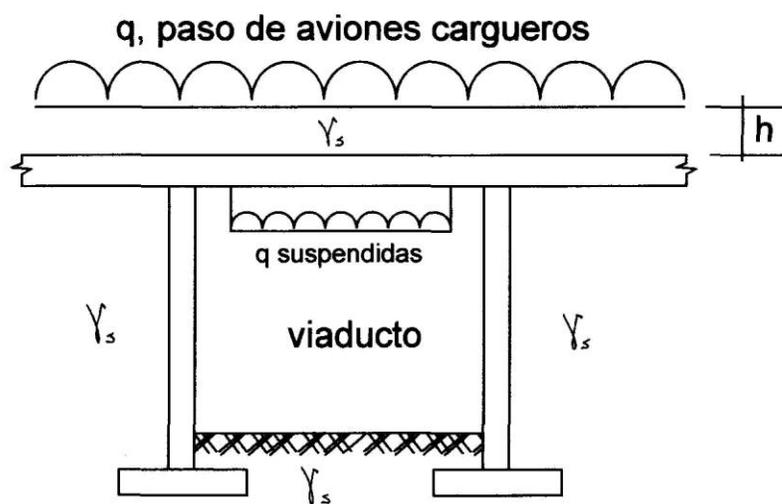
Mecanismo de funcionamiento de muros de concreto reforzado en túneles
